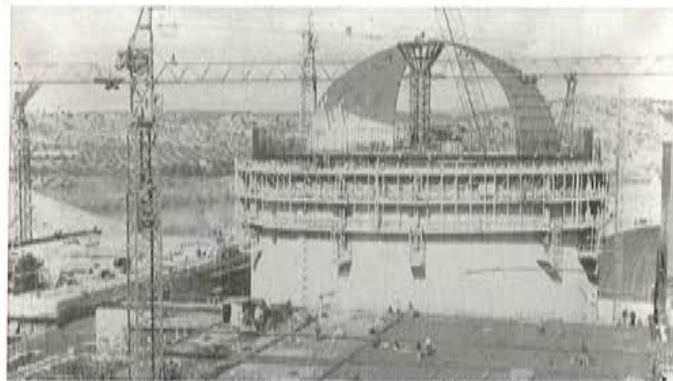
Encofrado Trepante para el muro del Ed. Contención.
